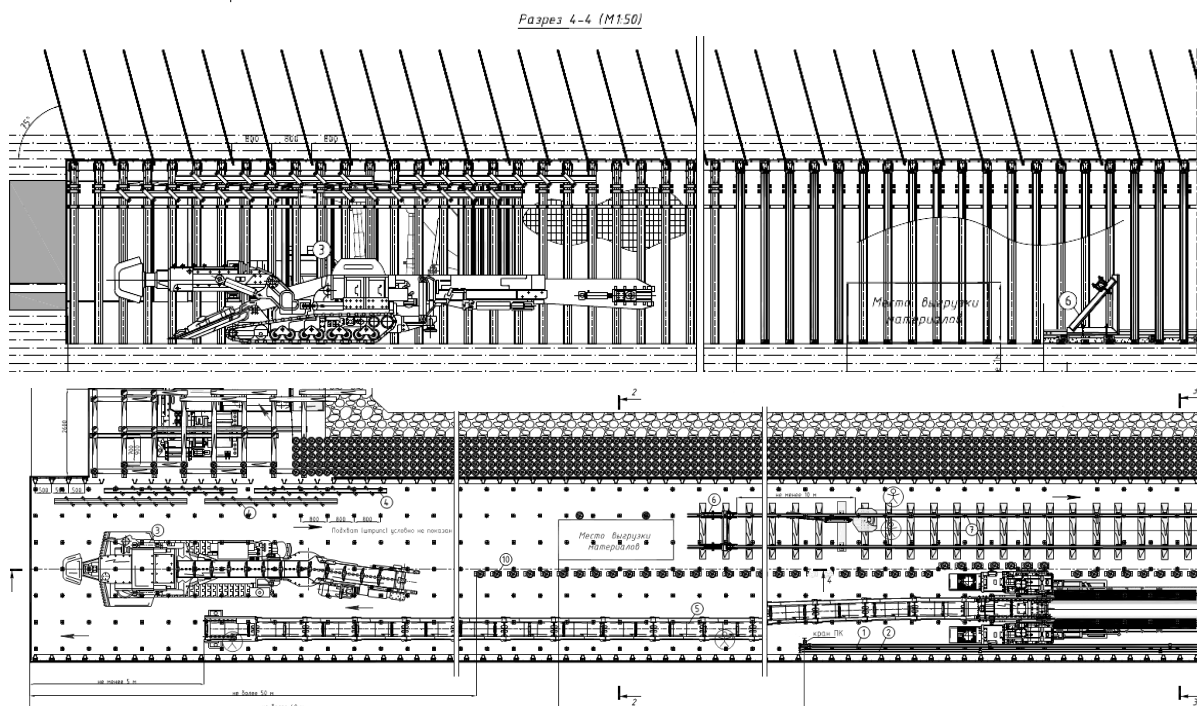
Паспорт проведения и крепления конвейерного штрека 25 ЗКШ: продольный разрез и вид сверху
